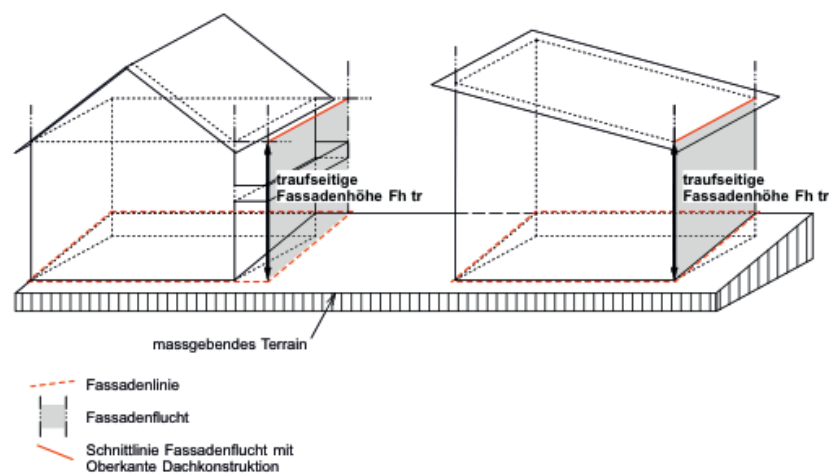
Fassadenhöhe traufseitig bei Gebäuden mit Schräg- oder Pultdach
